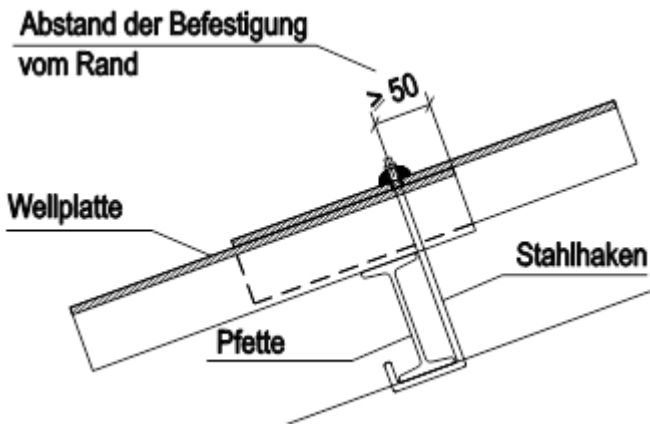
Befestigung auf einer Stahlpfette mit Stahlhaken S235 JR nach DIN10025
